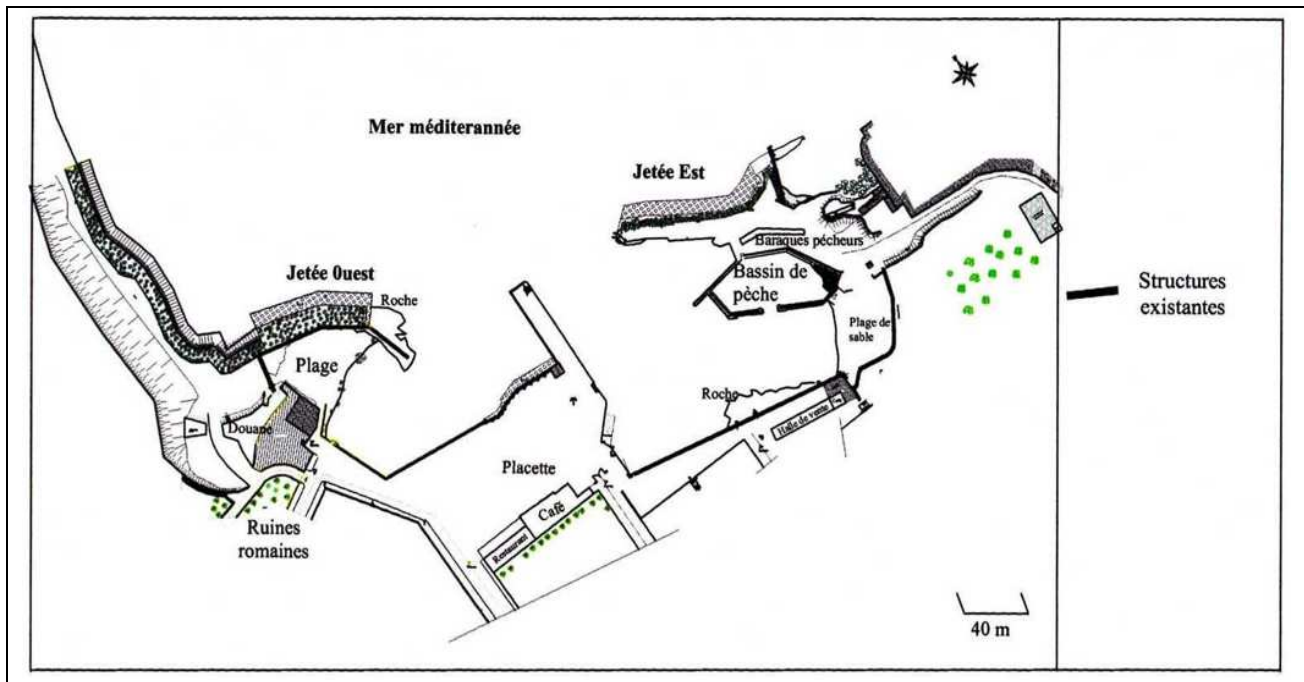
Plan du port de Tipaza avant travaux (2005).
